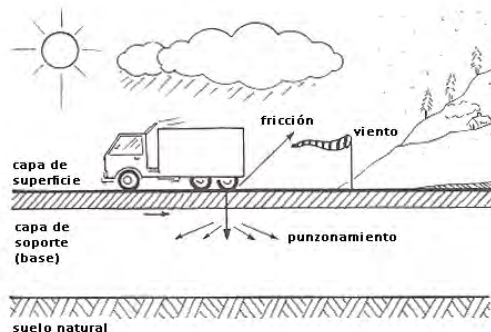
ESTRUCTURA DE PAVIMENTO CON CAPA DE SUPERFICIE ESTABILIZADA
